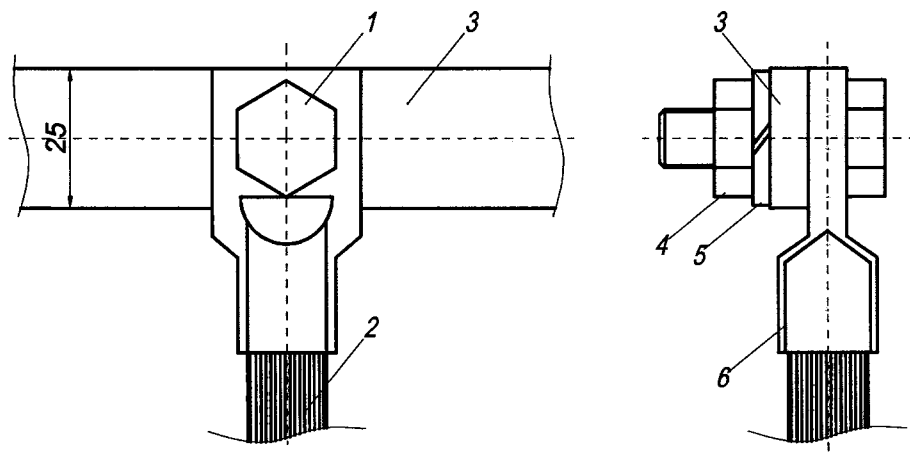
Схема присоединения заземляющего проводника из троса к заземляющему контуру или сборной заземляющей шине: 1 – болт; 2 – трос; 3 – контур или сборная шина; 4 – гайка; 5 – шайба; 6 – наконечник
